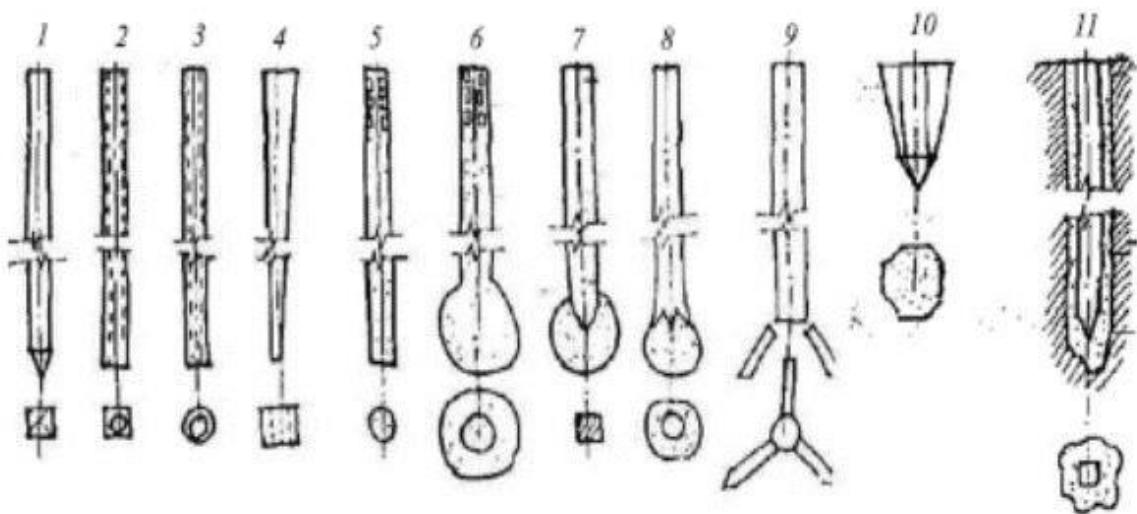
1,2,3,4 – бетонные и железобетонные сваи квадратные, круглые, сплошные, пустотелые; 5,6 – набивные обычные и с уширенной пятой; 7,8 – камуфлетные; 9 – с шарнирно раскрывающими упорами; 10 – призматические; 11 – свая в лидерной скважине
